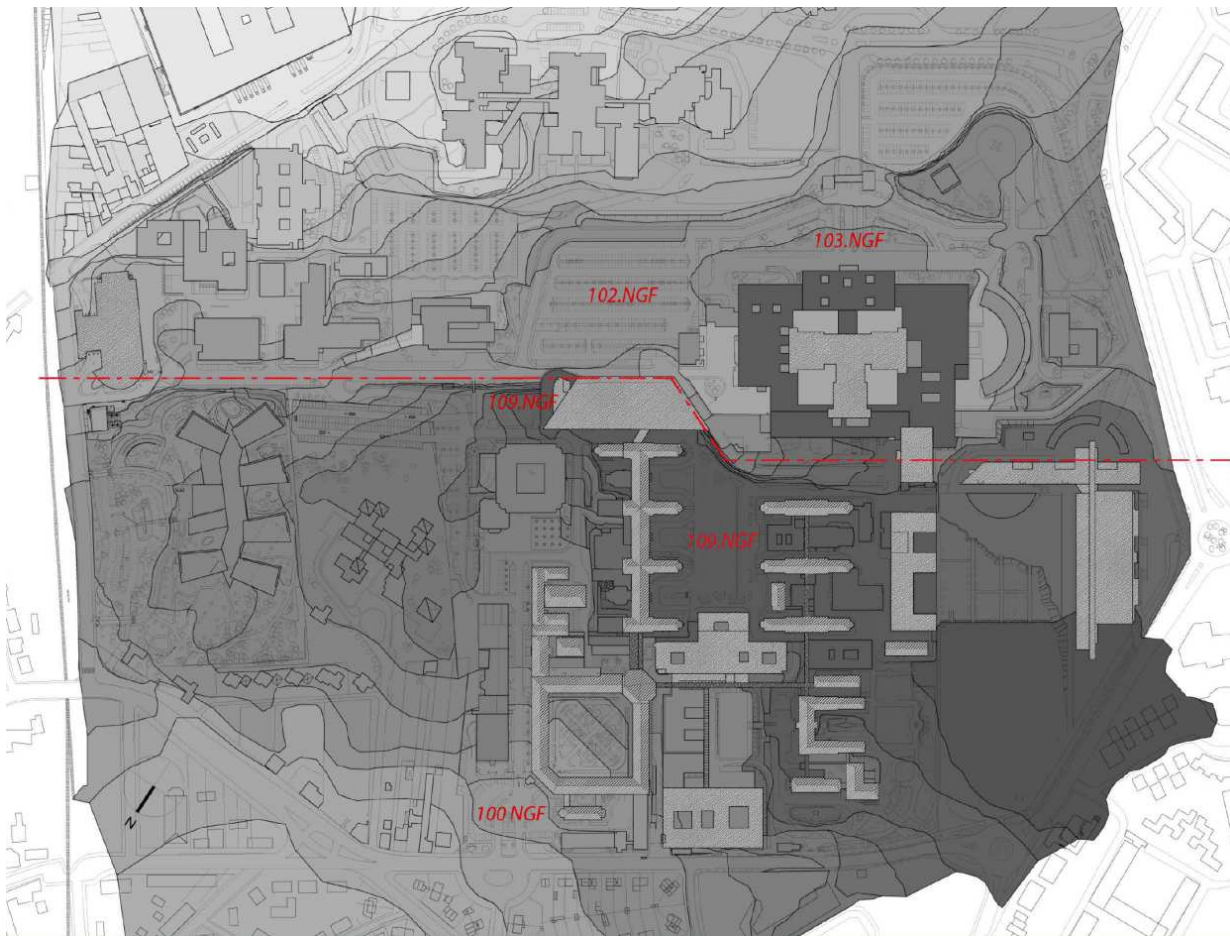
Plan topographique du site du CHU de Reims (source : APS)
